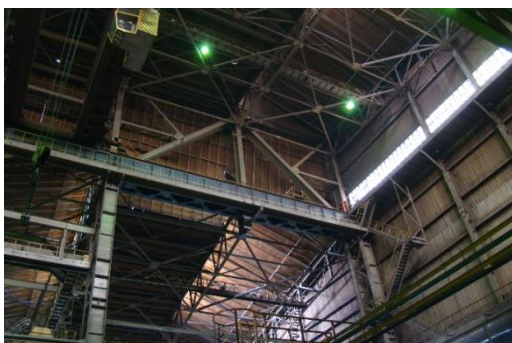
Подкраново-подстропильная ферма по ряду Б, оси 14' – 16'
